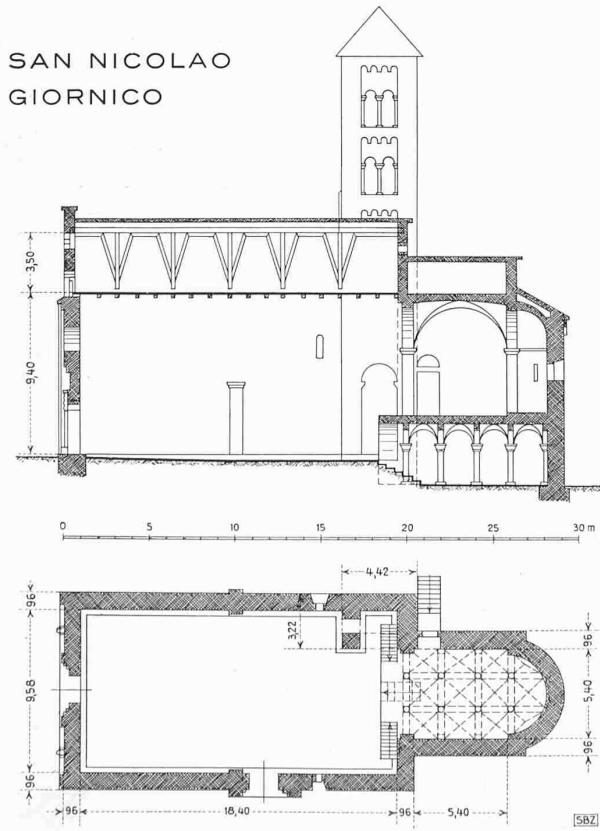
u. 5. Grundriss und Längsschnitt. — Masstab 1:400
